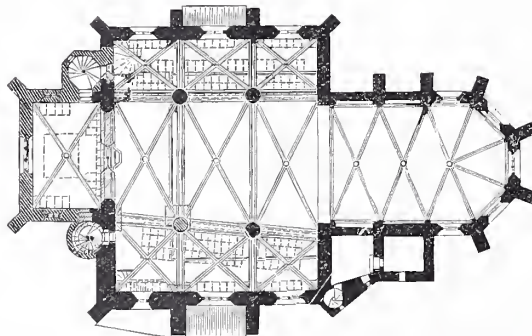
Pfarrkirche in Mögeldorf. Grundriss.
